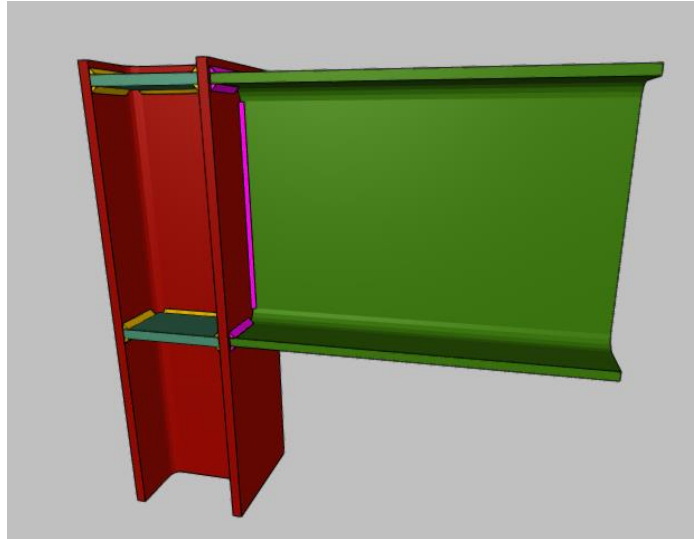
Ejemplo de unión pilar – viga rígida ejecutada con soldadura [7].
